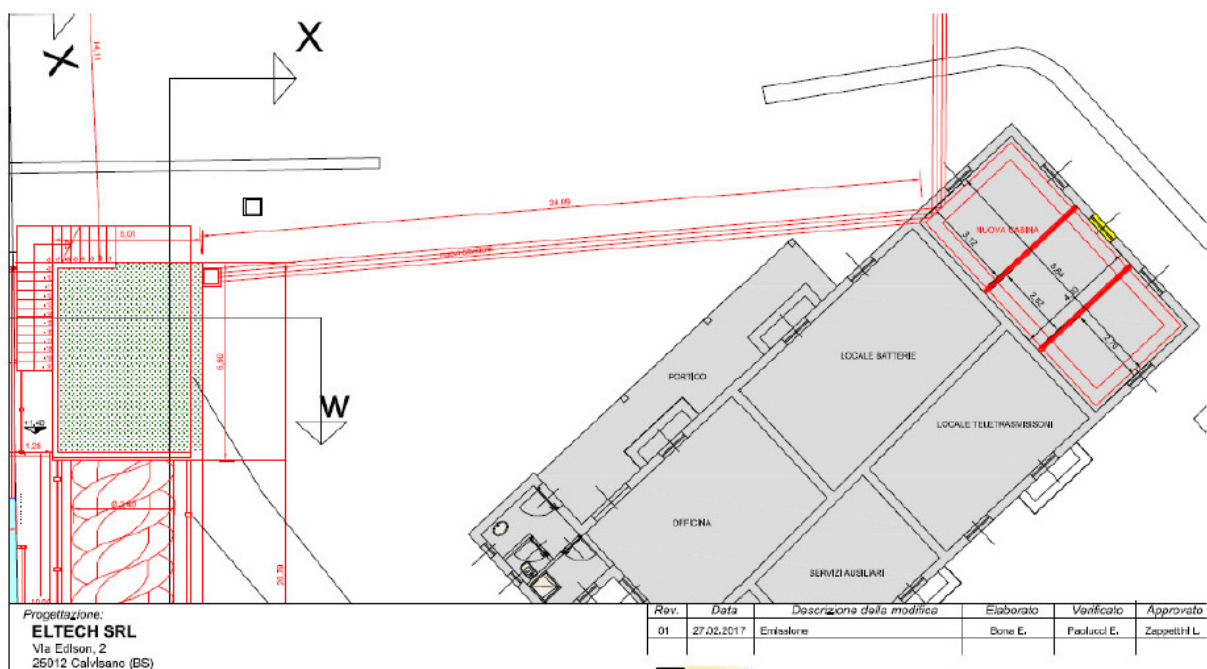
Planimetria pianta della nuova cabina con collegamento al nuovo impianto turbina.
